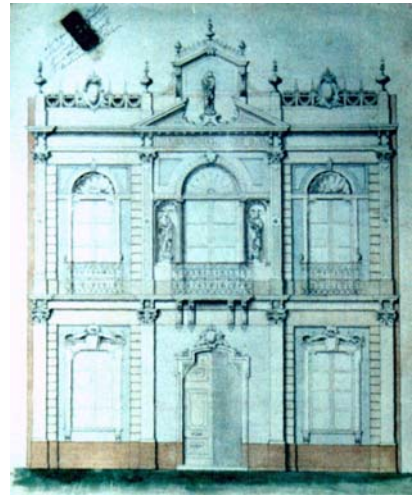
Fachada com fundo azulado e pilastras claras. Foto: Natália Naumova.
